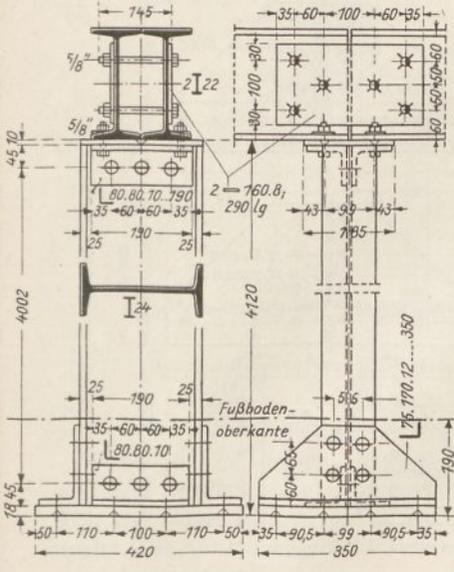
Kopf und Fuß einer Stütze aus einem I-Normalprofil.
